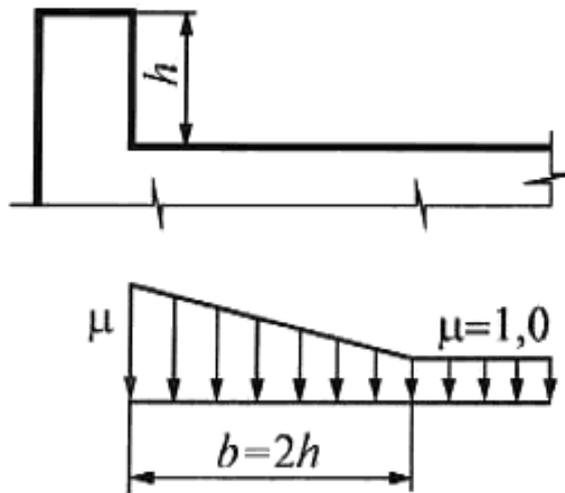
Схема распределения нагрузки на покрытие возле парапетов
